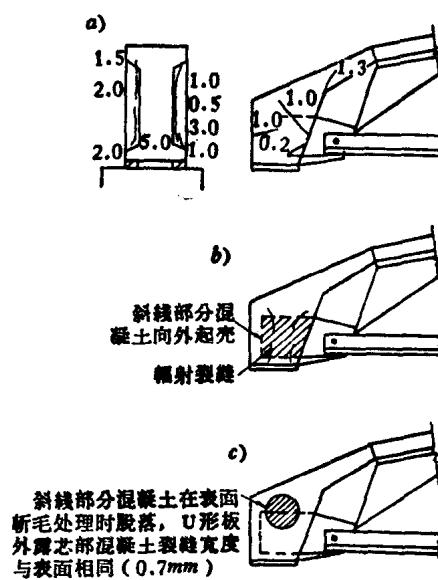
用角钢作下弦的钢筋混凝土拱形屋架端节点范围的裂缝图
